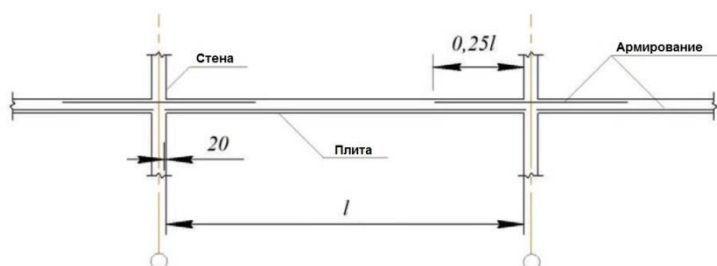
Вариант конструктивного решения монолитного перекрытия при строительстве стеновой структурной системы.
